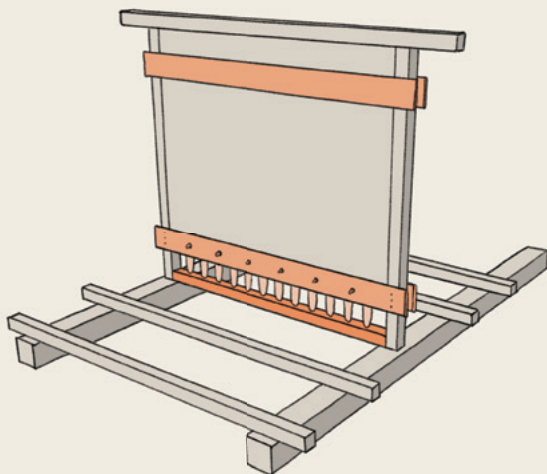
Operações de estabilização para substituir viga de sustentação de parede mista.
